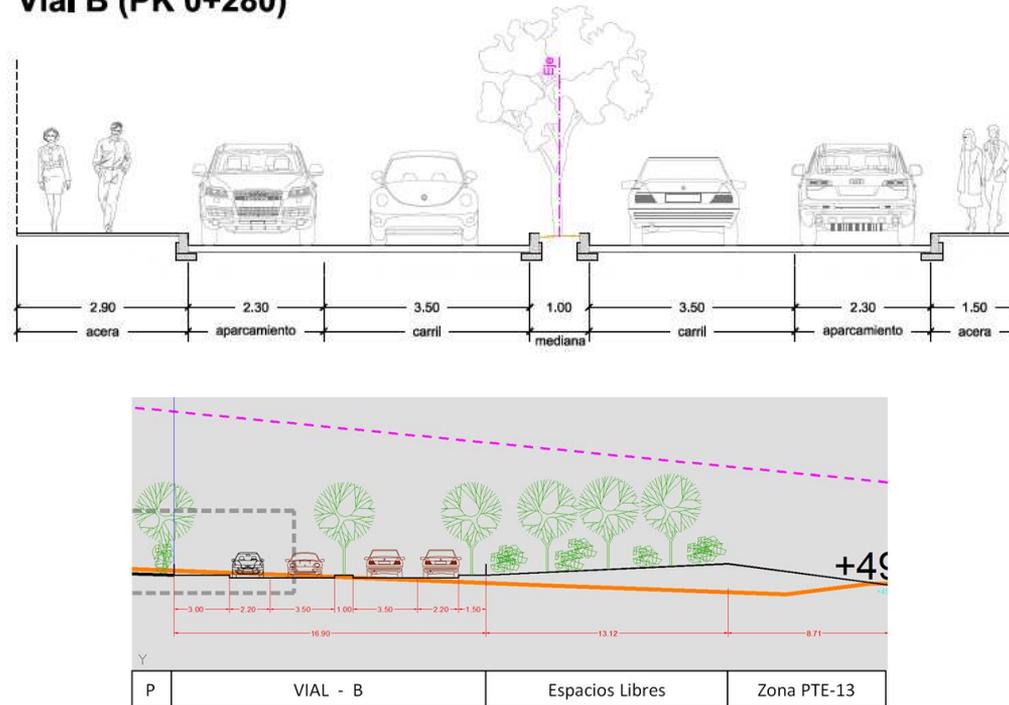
Sección tipo Vial “B. Elaboración propia.
